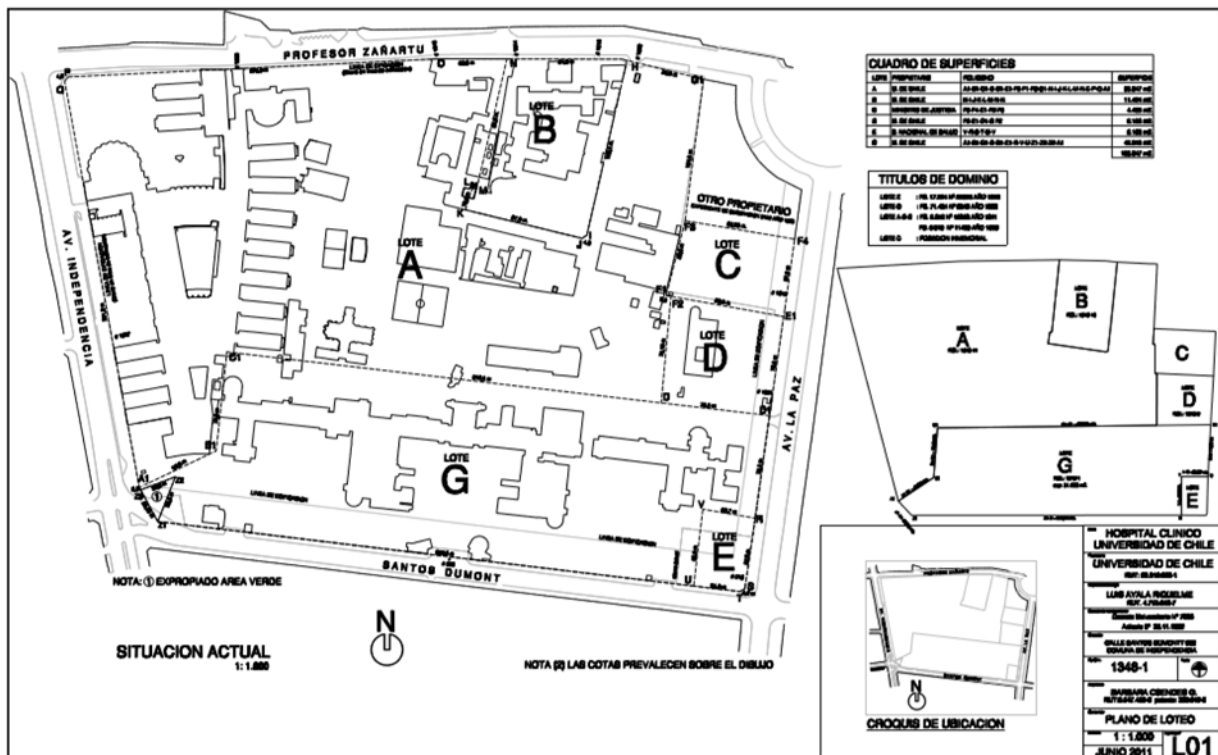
Plano de loteo y emplazamiento del Campus Eloísa Díaz¹
